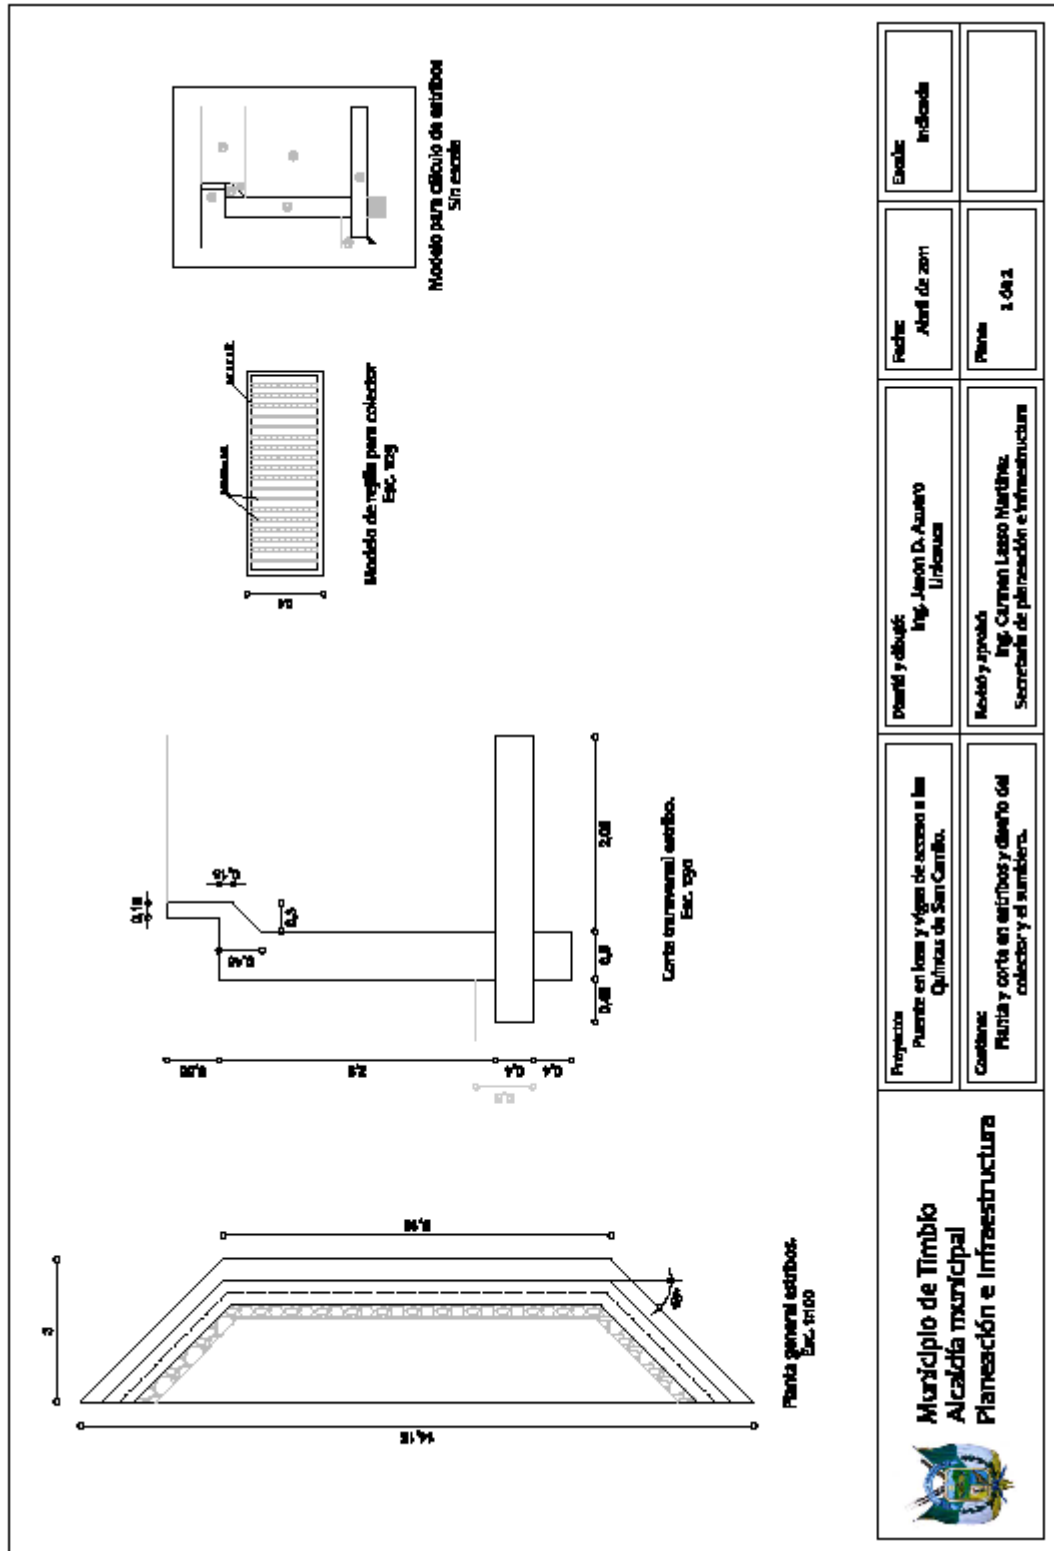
Planta y corte en estribos, y modelo del colector y sumidero (ver Anexo 3).
